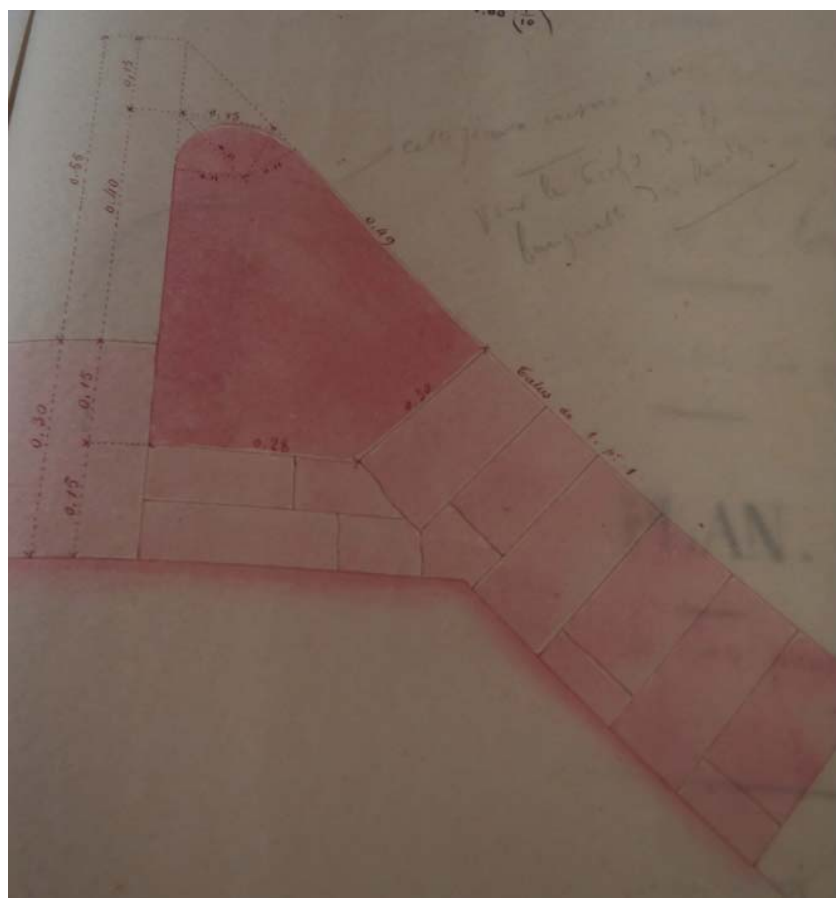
Profil de la banquette sur la levée de Sermoise 1^{re} section - Source : archives DDT 58
